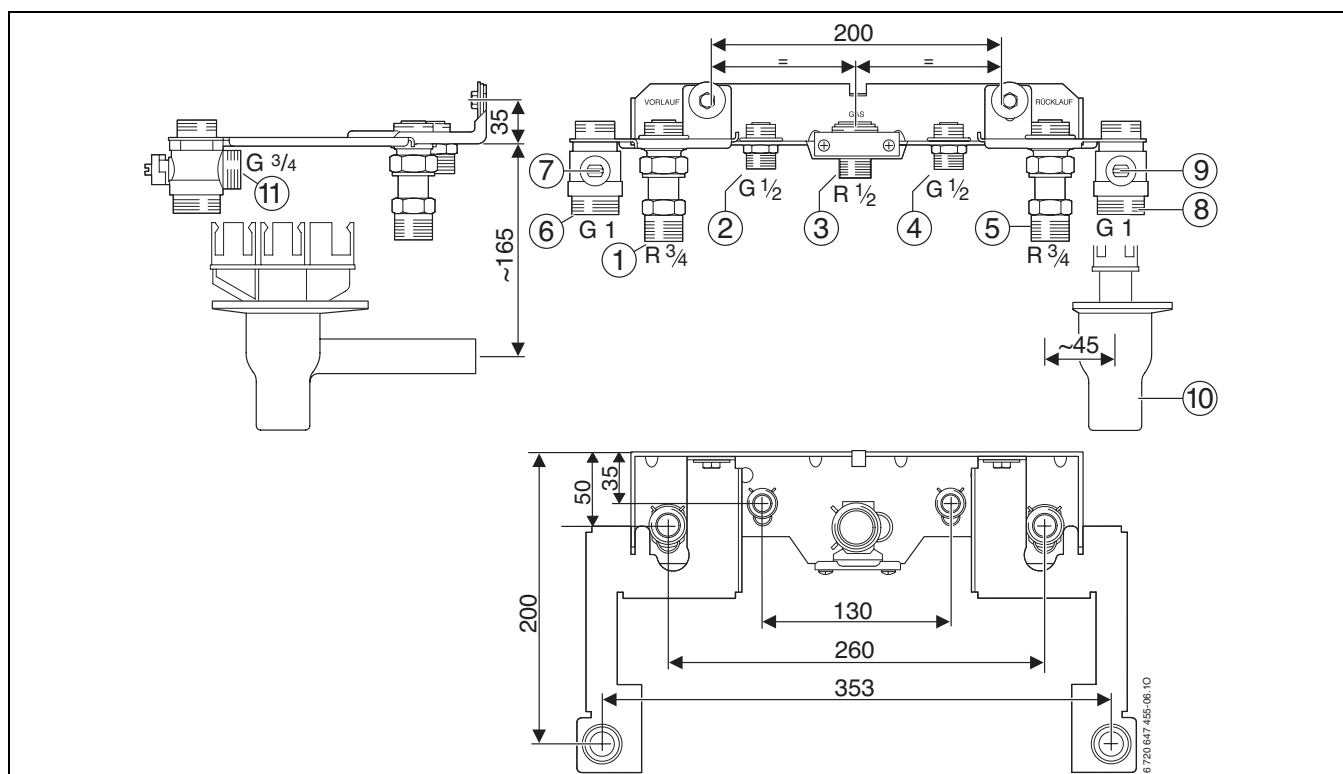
Esempio: piastra di collegamento per il montaggio U-MA con la prolunga per il collegamento dell'accumulatore inerziale e set di collegamento AS6-AP
